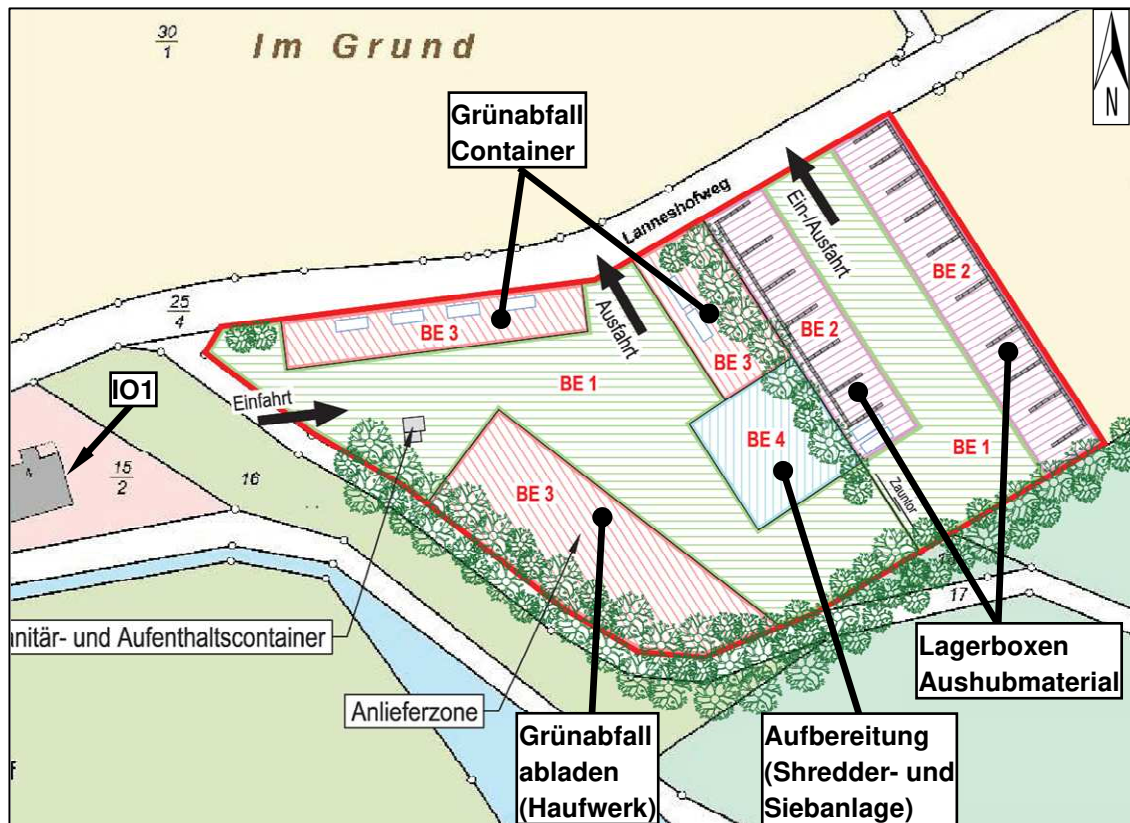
Lageplan des geplanten Zwischenlagers – kein amtlicher Maßstab
